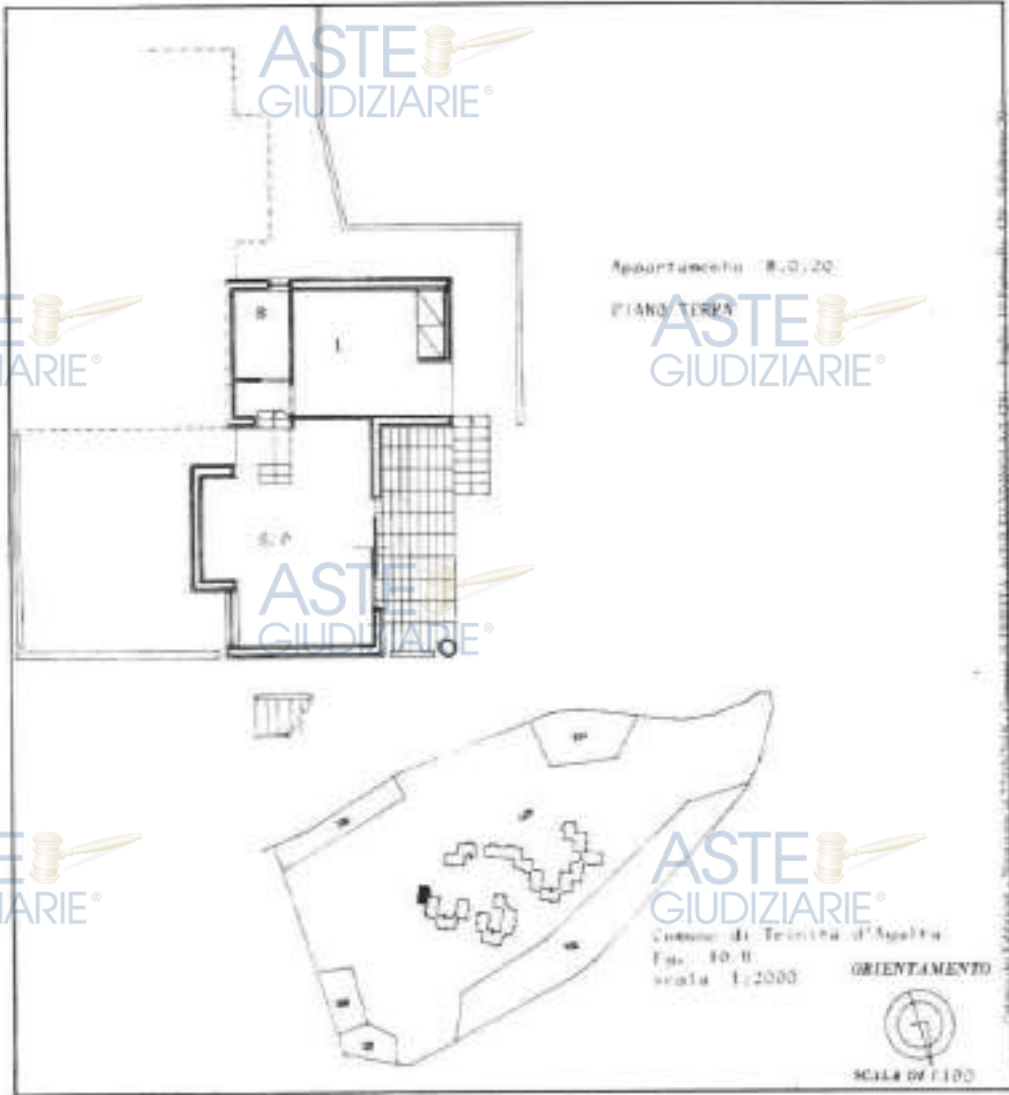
Visura planimetrica catastale Fig. 10 Part. 429 Sub 60 (ex Fig. 10 Part. 429 Sub 19)
